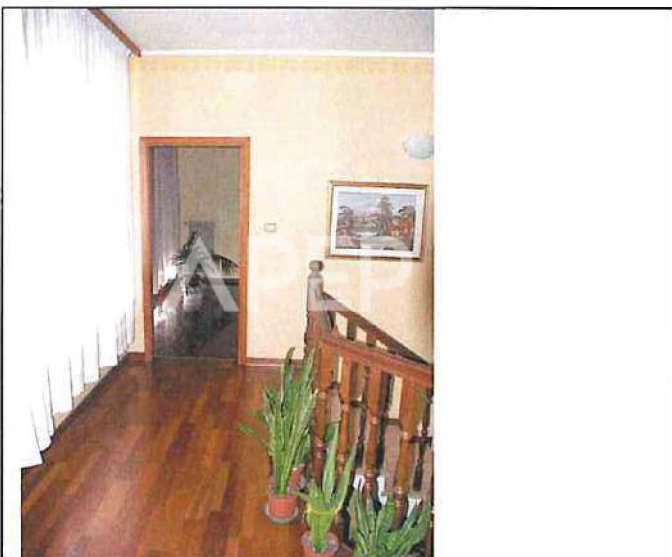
Piano primo corridoio – scala ed ingresso camera doppia.
